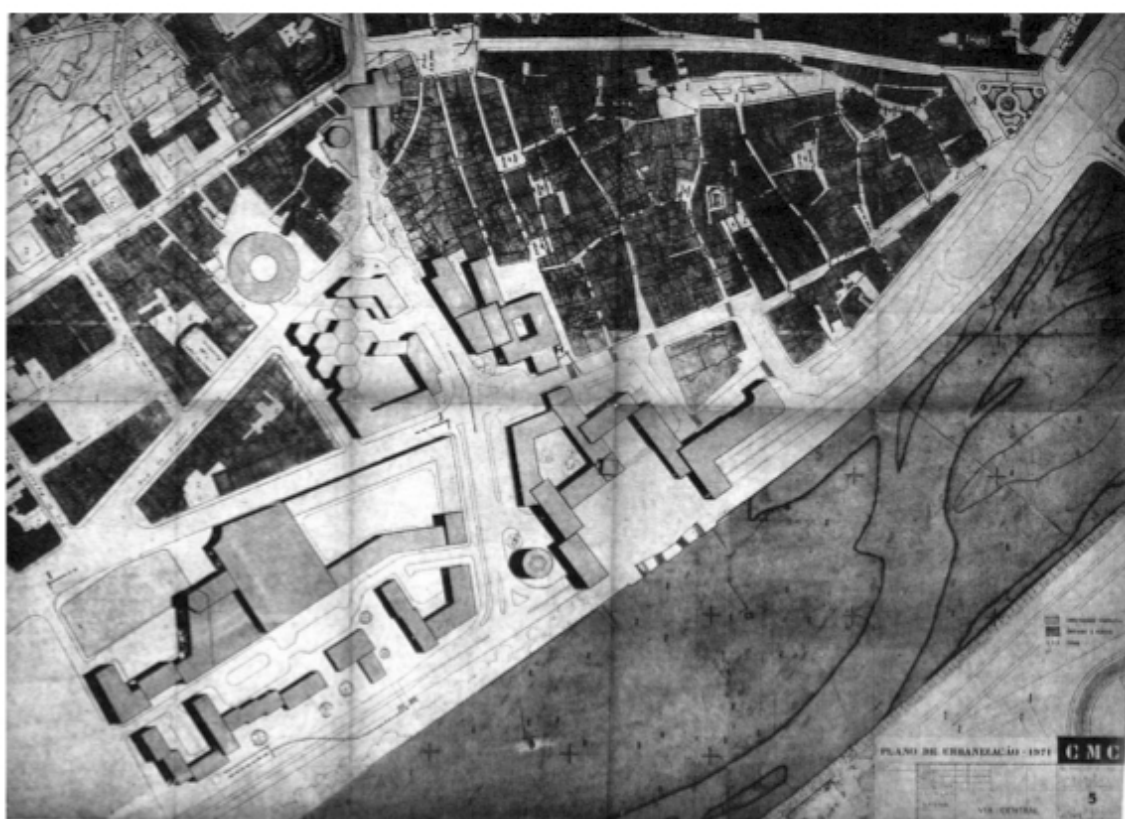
Pormenor da Baixa, Plano de Coimbra - Costa Lobo
